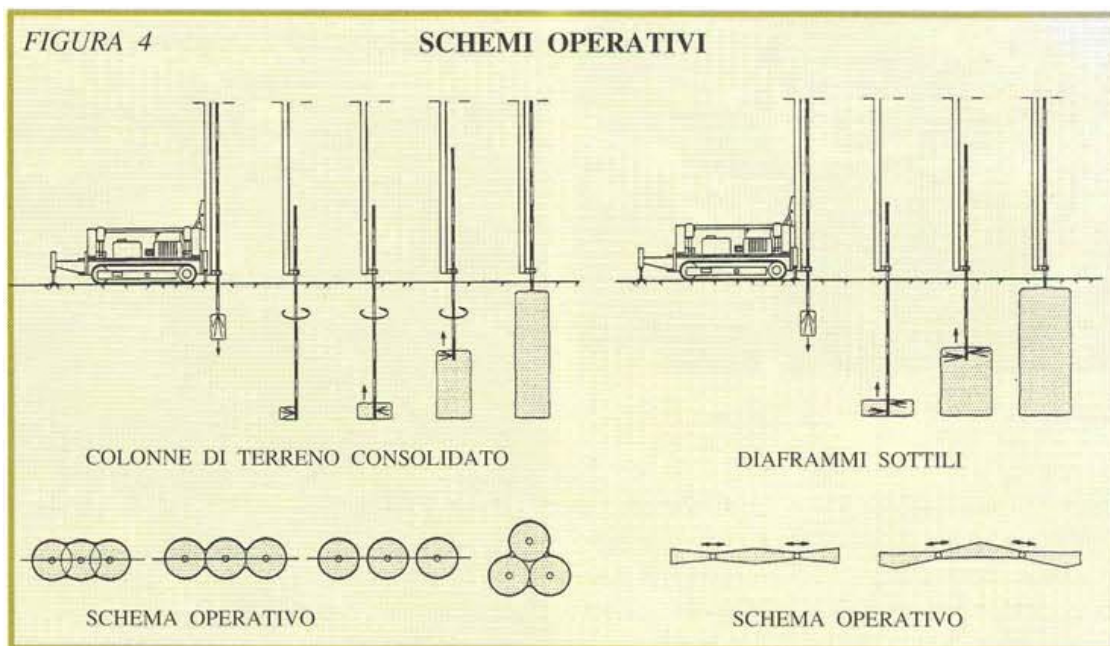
Schema operativo di realizzazione impermeabilizzazione colonnare con jet-grouting
